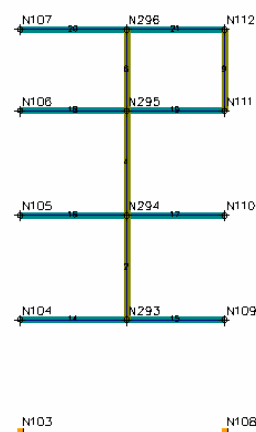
Schematizzazione a telaio equivalente delle parete 17
